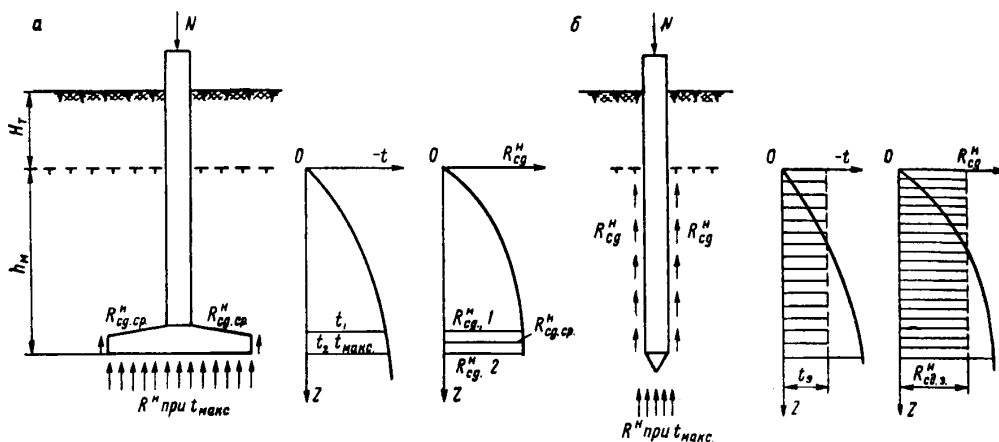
Расчетные схемы на вертикальную нагрузку фундаментов
